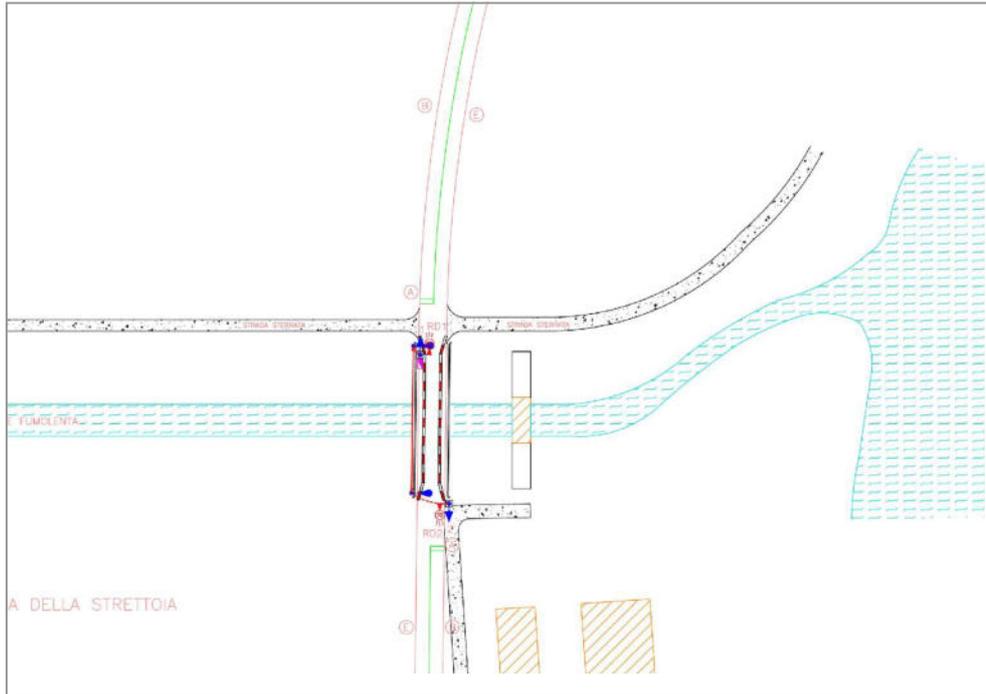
TAV.1: PLANIMETRIA INTERVENTO DEL PONTE SUL CANALE FUMOLENTA - SP60 DI SORBOLO - COENZO
